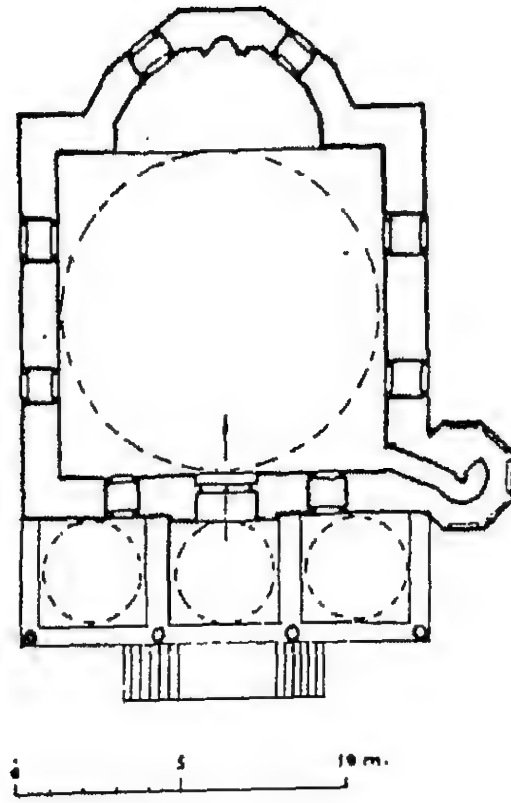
مسقط أفقي لمسجد Hadun في ياكوفكا (عن: Pašić).
